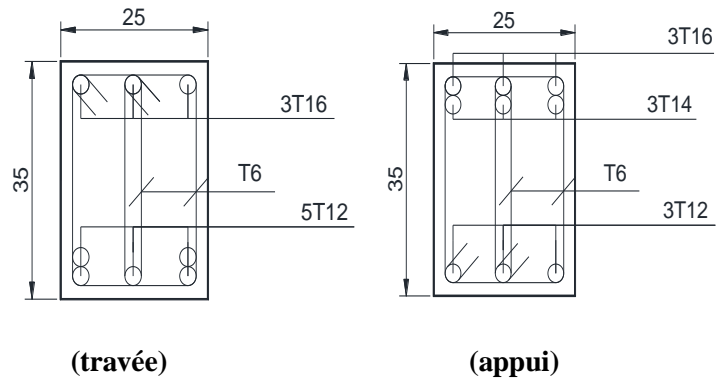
Ferrailage d'une poutre principale 25x35cm (bâtiment R+10)
